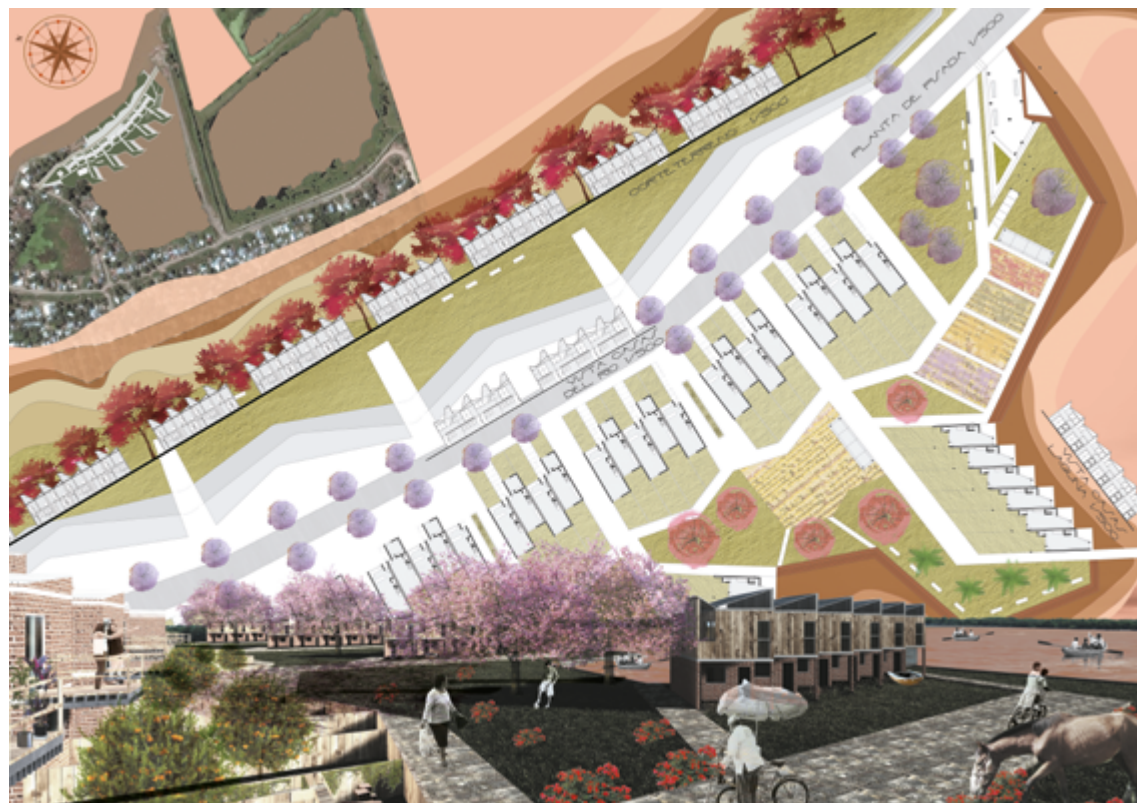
Conjunto de viviendas entre el río y la laguna. Alum.: Cassadey/ Jellic/ Ferrario.
